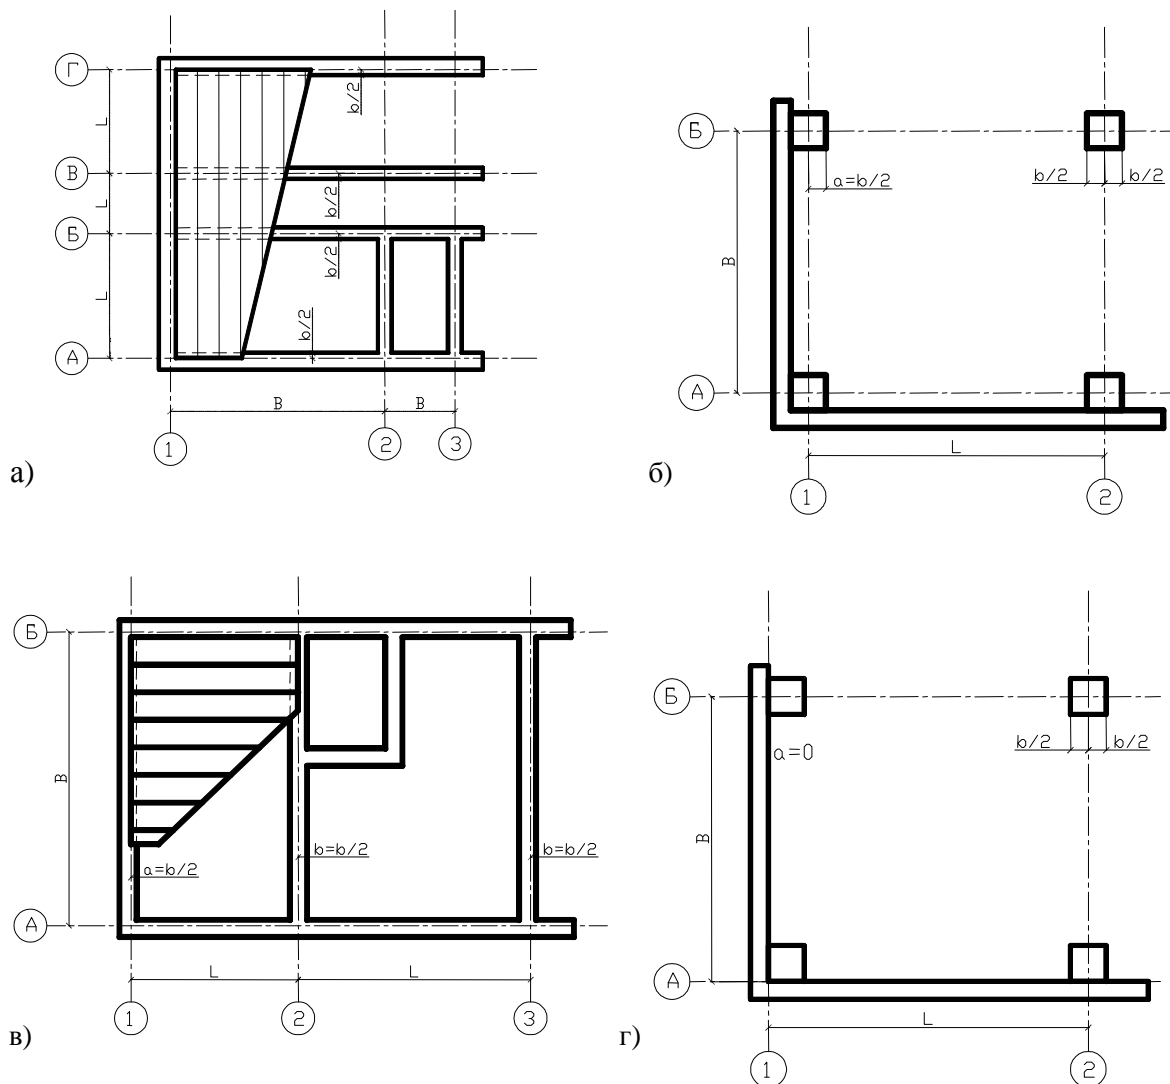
Примеры привязки стен к модульным разбивочным осям в плане здания: а – здание с продольными несущими стенами (привязка  $b/2$ ); б – то же, с поперечными (привязка наружных продольных стен нулевая); в – крайний пролет каркасного здания (привязка нулевая); г – то же, привязка  $b/2$ ;  $B$  – шаг,  $L$  – пролет
